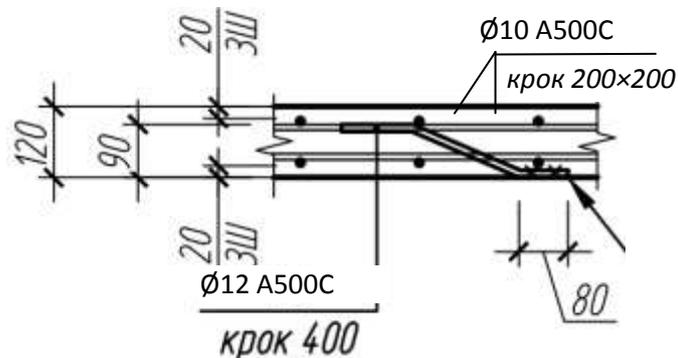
Влаштування анкерів до верхньої полицки двотаврів та армування монолітної залізобетонної плити
